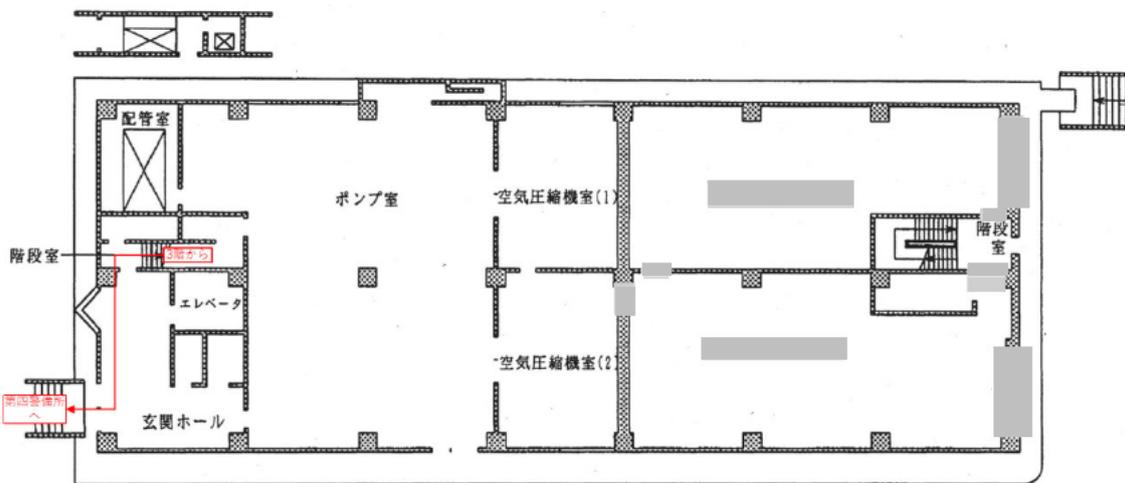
(2) 移動経路 (ユーティリティ施設 地上 1F 平面図)
